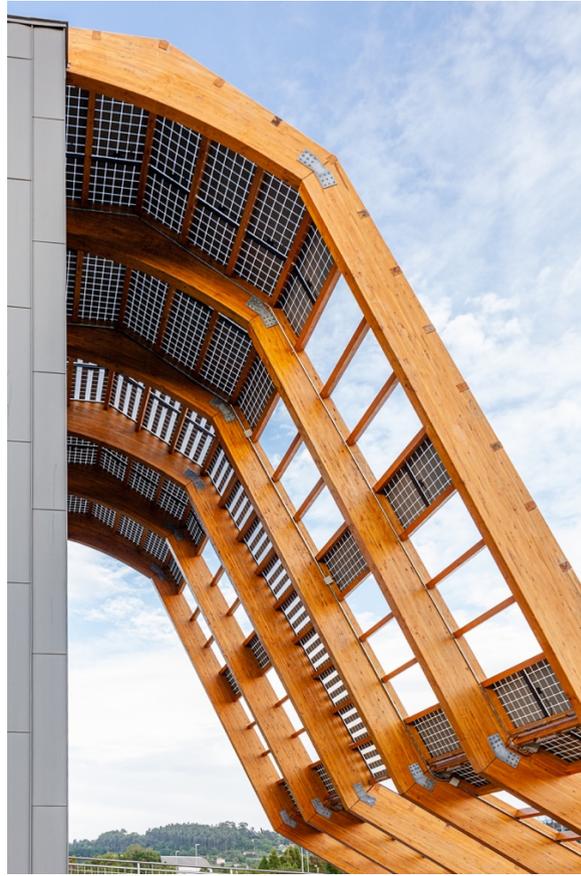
Fotografía Estructura de madera y paneles fotovoltaicos en fachada sur.
